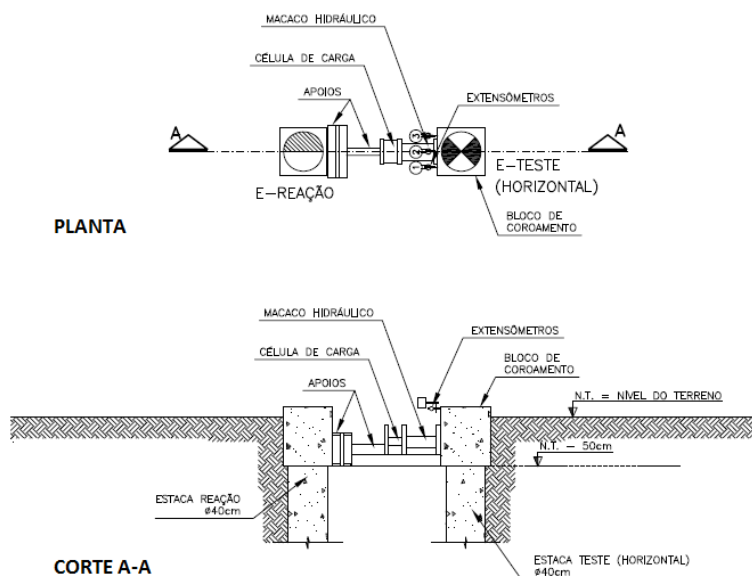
Aparato de montagem do ensaio de carregamento horizontal
